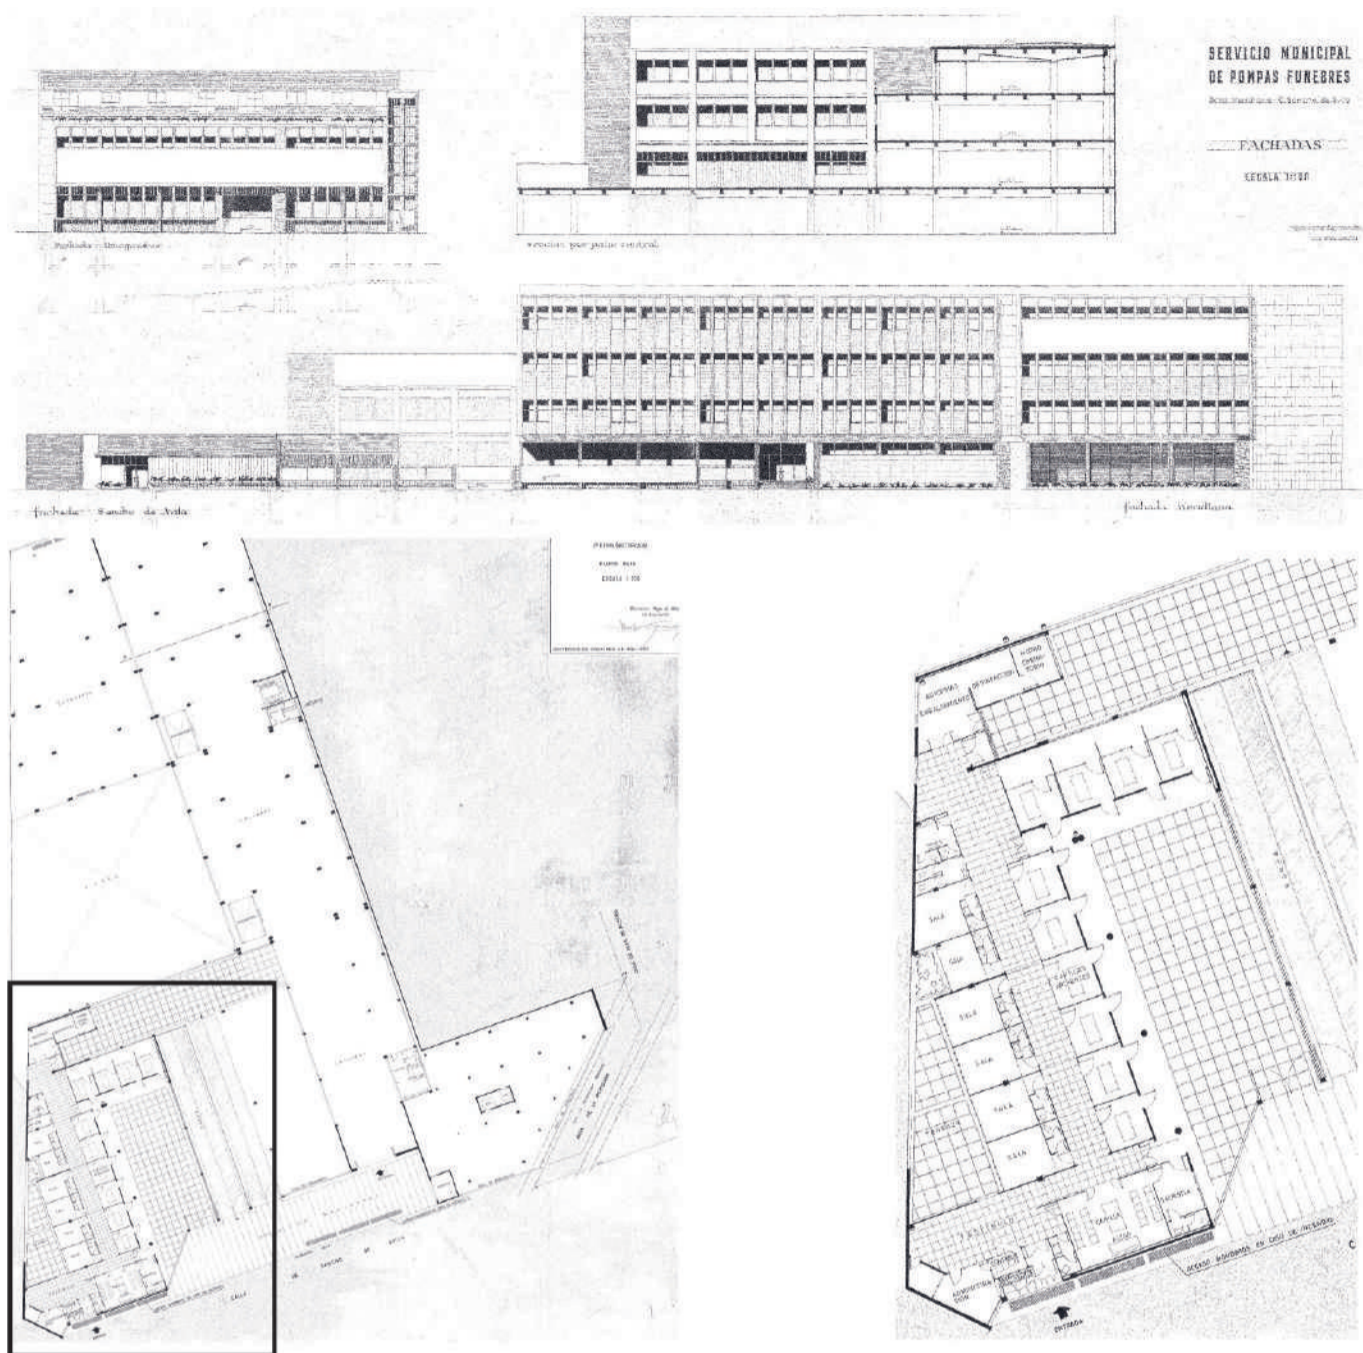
Josep Maria Soterias i Mauri y Enric Giralte i Ortet, Anteproyecto de edificio para los servicios municipales de Pompas Fúnebres: plano de fachadas sobre calles Almogaváres, Sancho de Ávila y Meridiana. Abajo, plano de planta baja, y detalle ampliado del sector de acceso y capillas ardientes sobre calle Sancho de Ávila y, 1959. Documentación cedida por Fundación Mémora.
